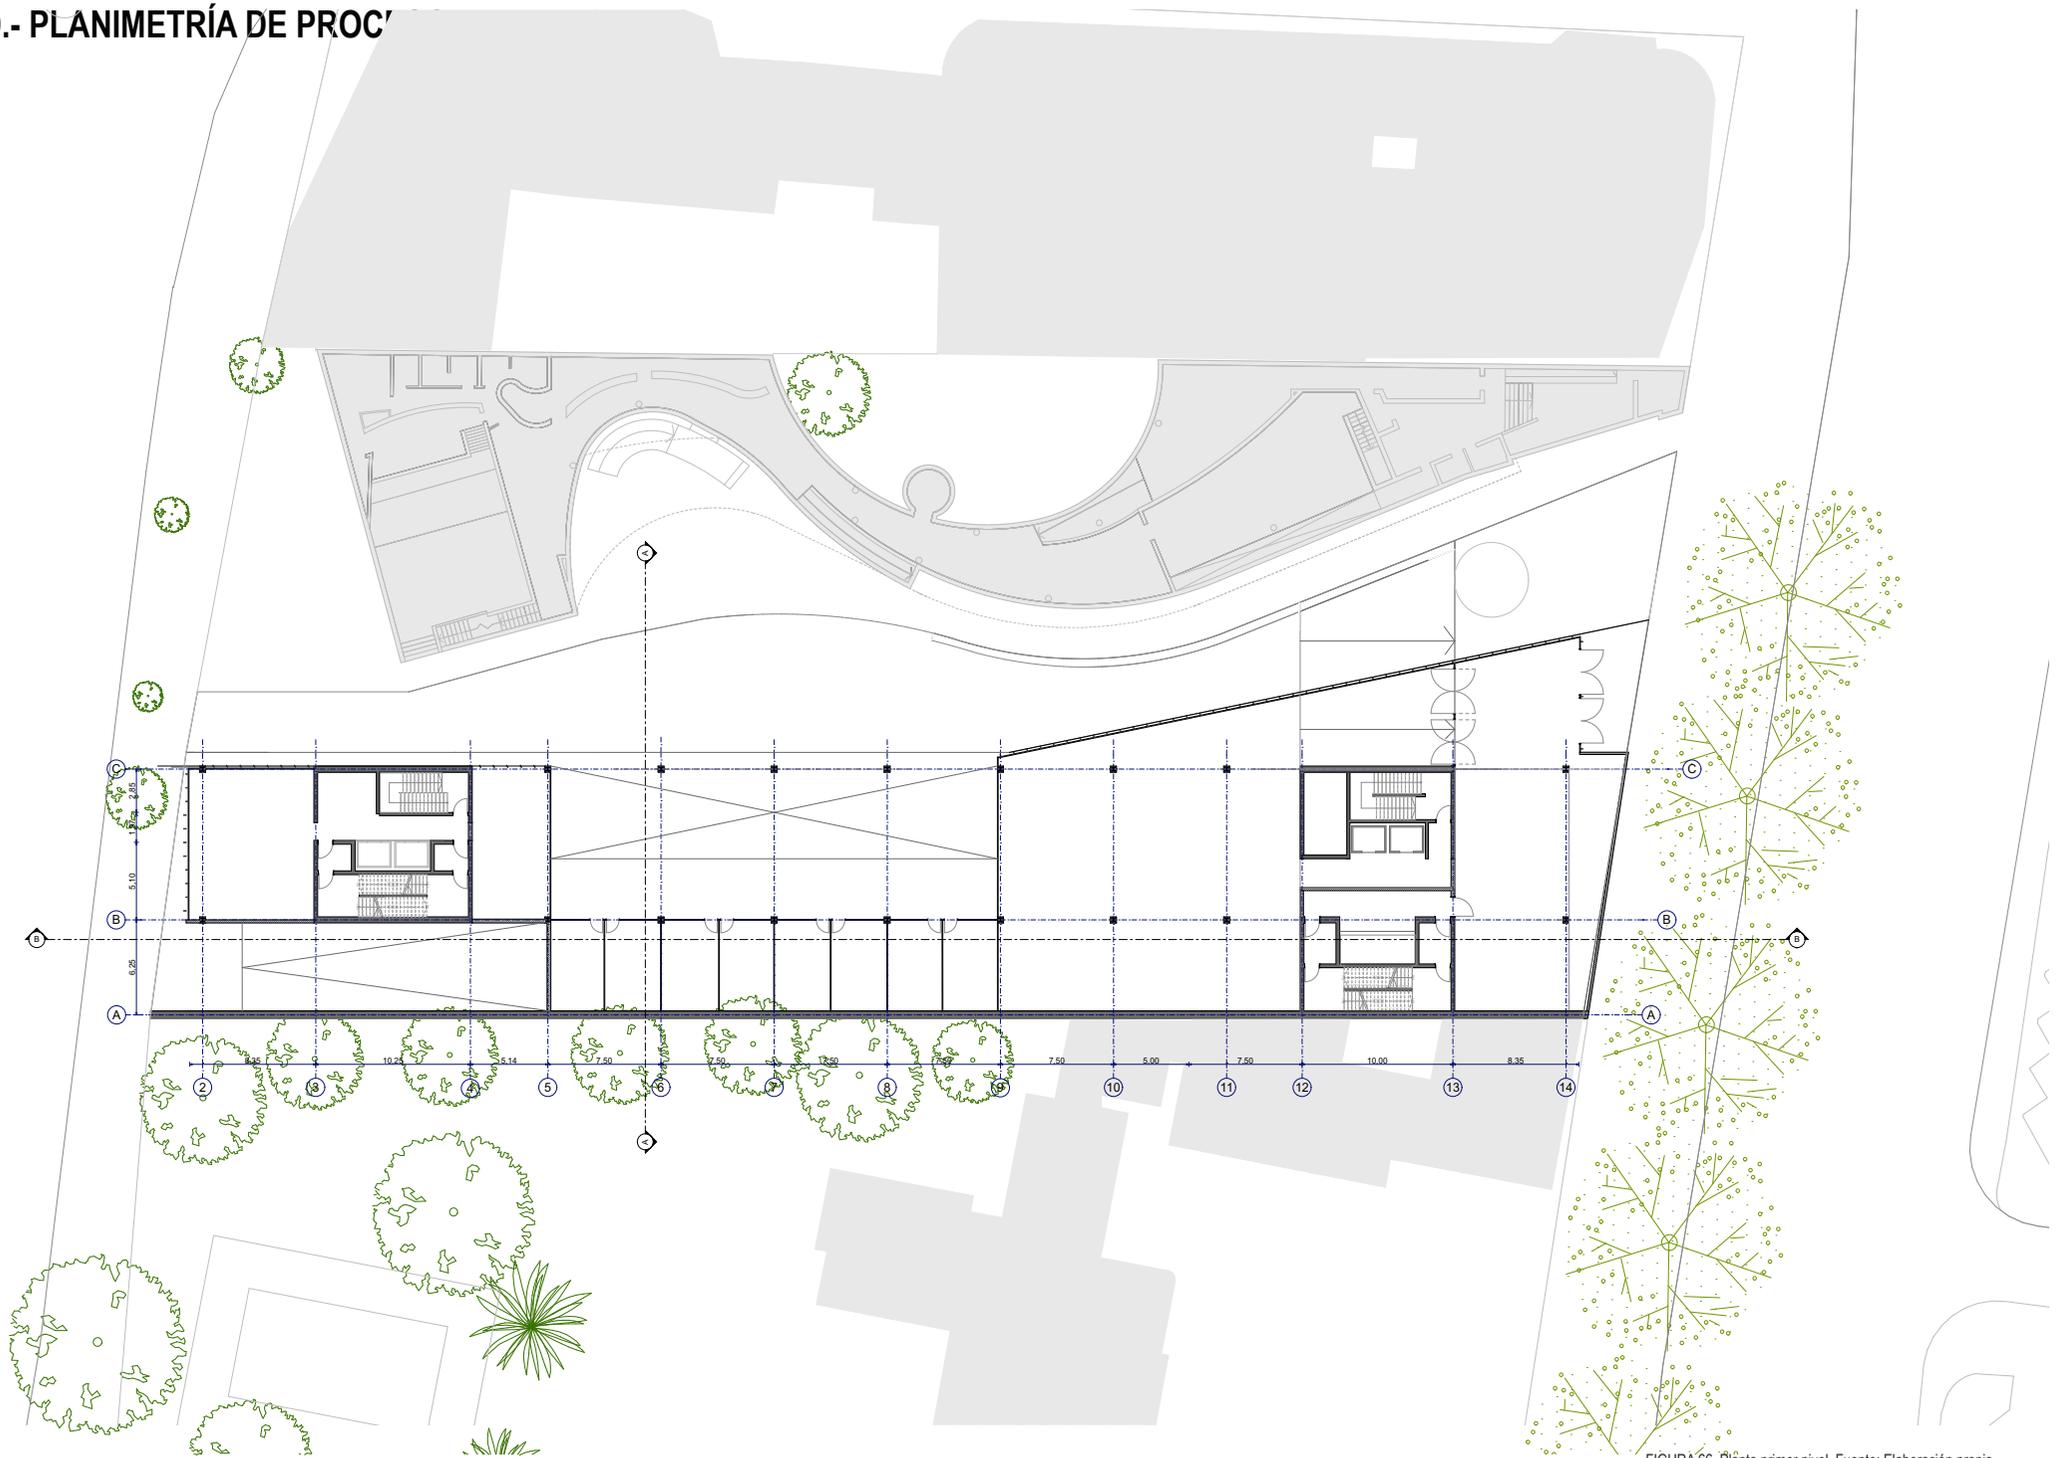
Planta primer nivel. Fuente: Elaboración propia
